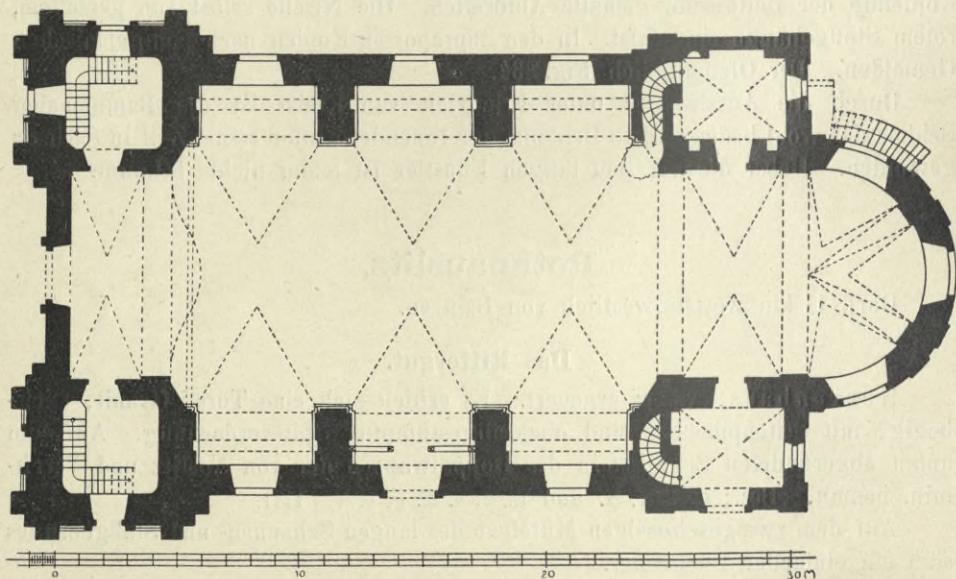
Schirgiswalde, Kirche, Grundriß.
